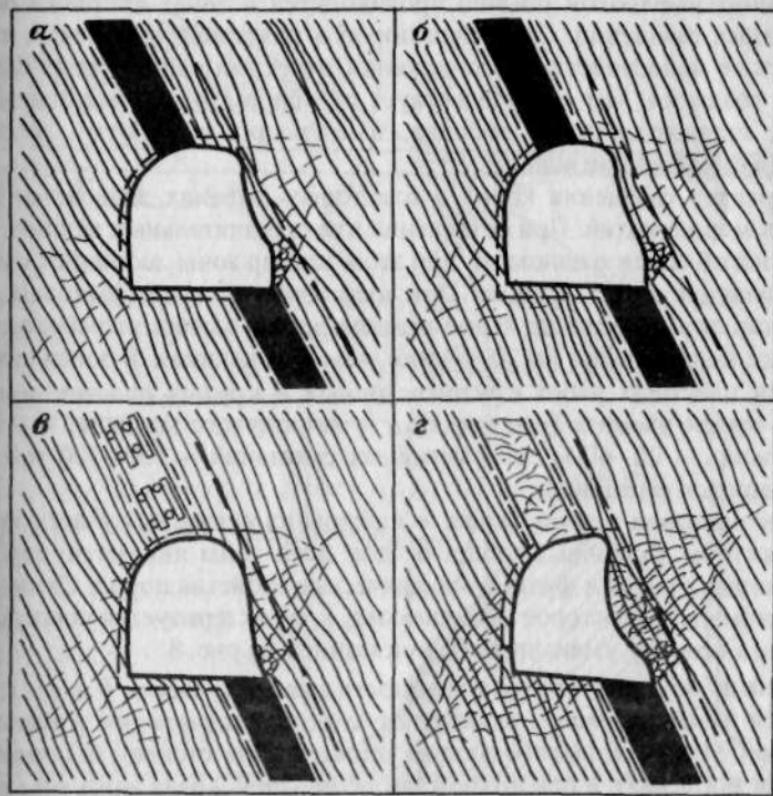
Схема развития смещений пород в пластовую выработку при разработке крутонаклонных и крутых пластов
